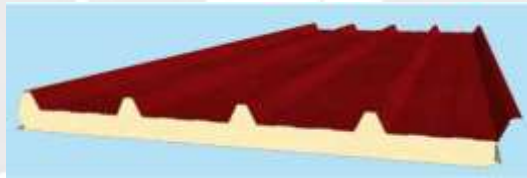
Panal de tipo Sandwich prefabricado de PUR
